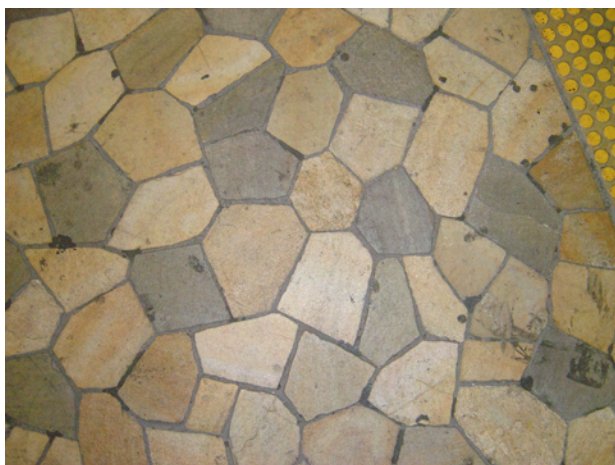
Banchina della stazione della Metro B alla Stazione Termini, con pavimentazione in quarzite di Barge (Cuneo).
